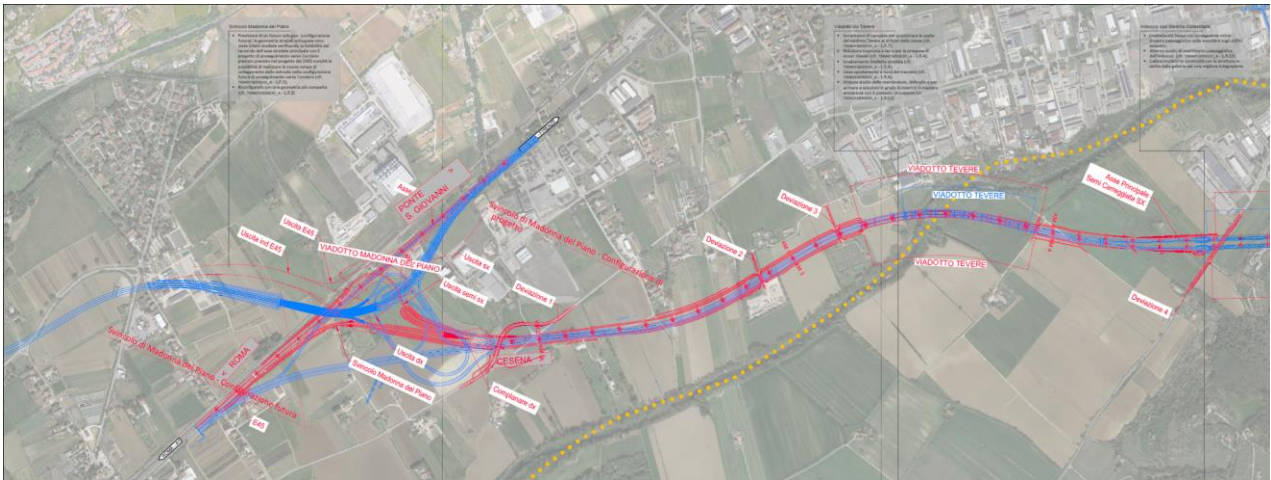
Confronto planimetrico (in rosso il progetto definitivo) – tav. 1 di 2
